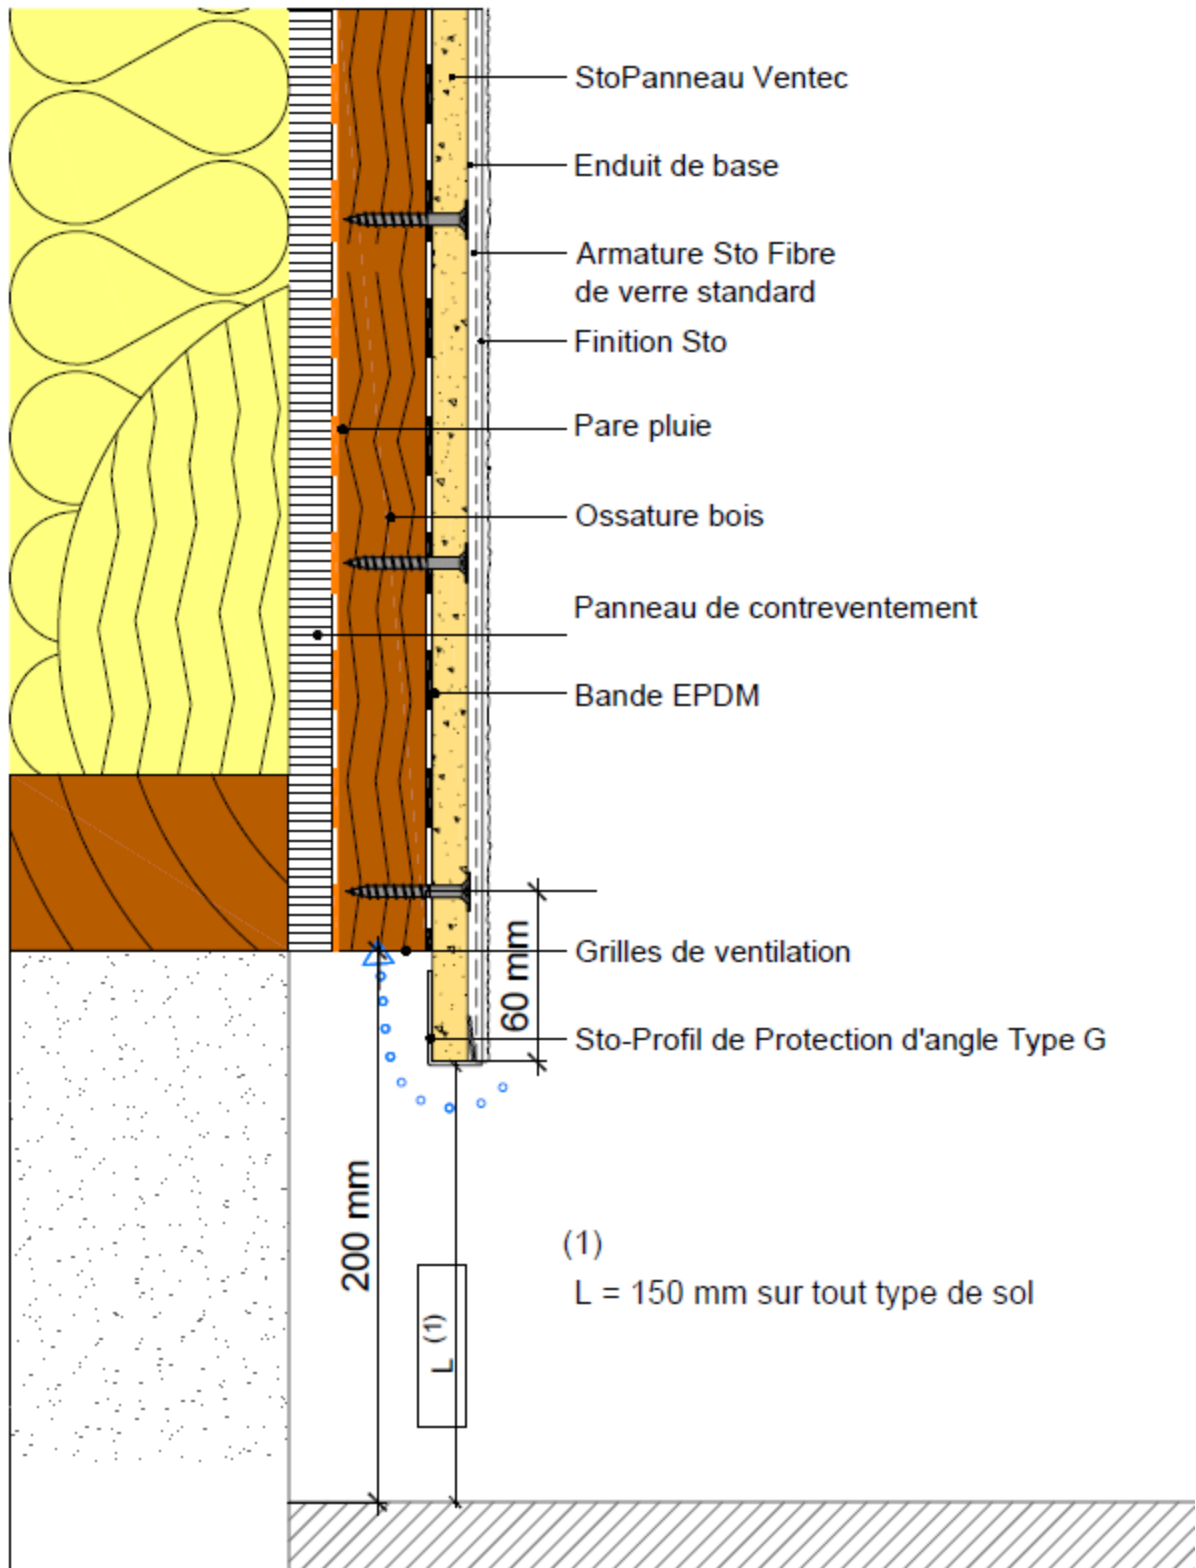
Coupe verticale - Pied de bardage - Ossatures bois sur COB
